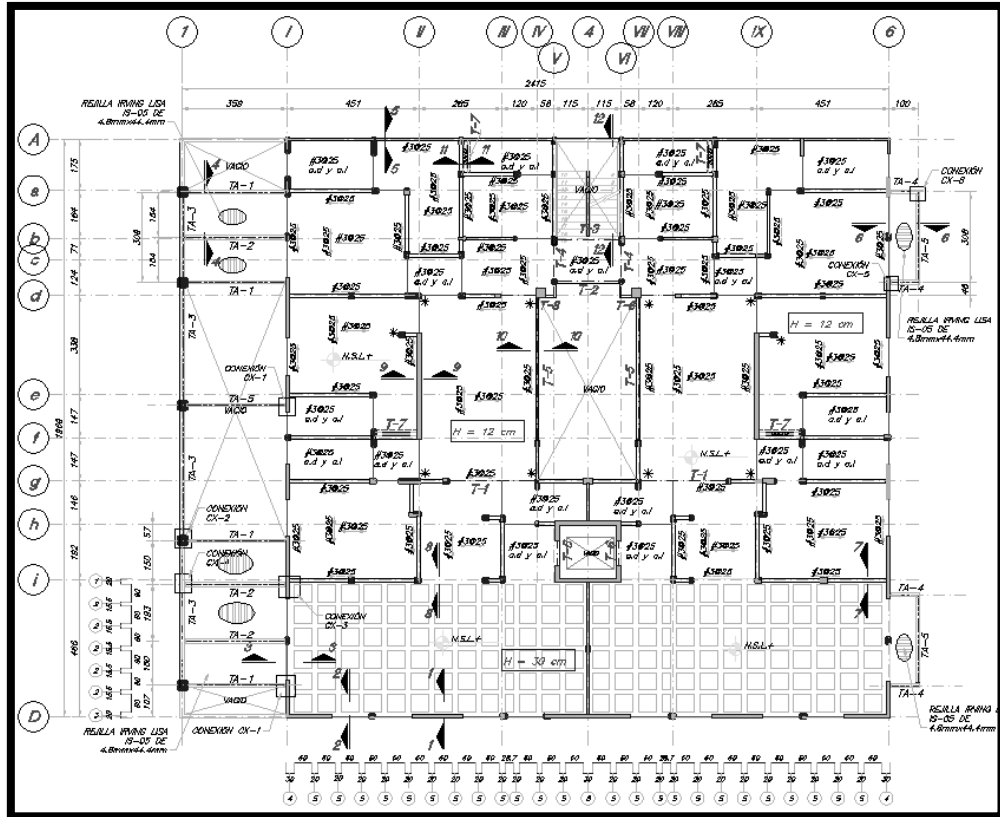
Planta estructural niveles 2, 3 y 4.
